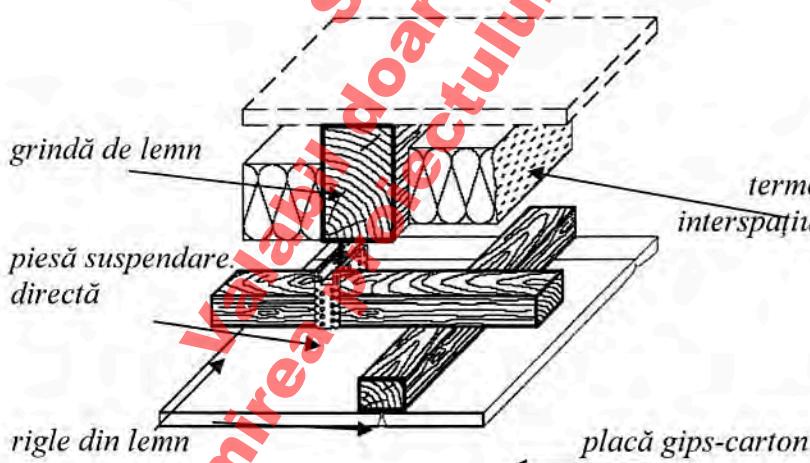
b Tavan pentru mascarea planșeelor cu grinzi din lemn pe structură de suspendare din lemn – fișa tehnică D151
